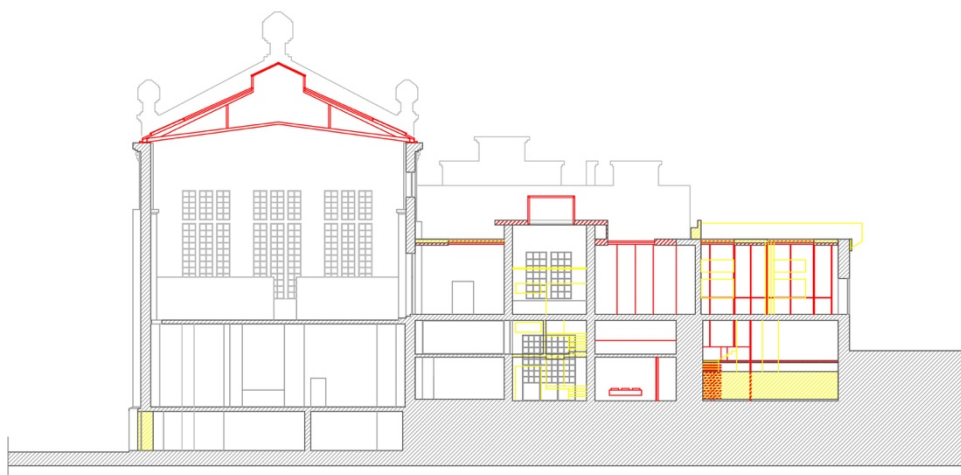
Sobreposição dos elementos a construir e a demolir, corte g;
